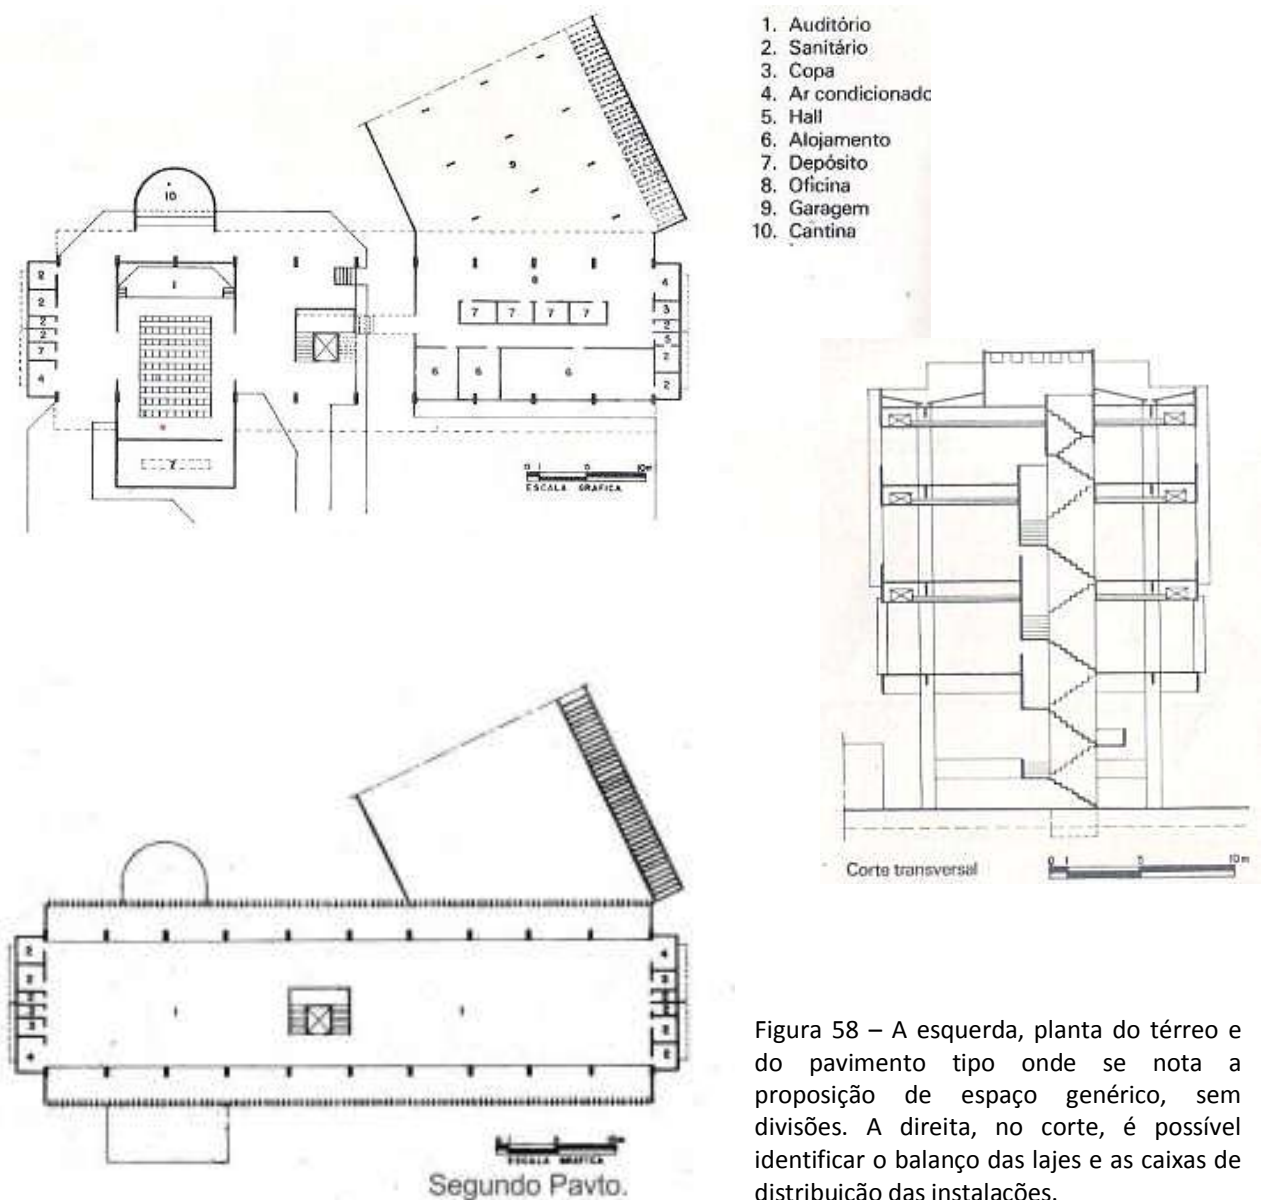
A esquerda, planta do térreo e do pavimento tipo onde se nota a proposição de espaço genérico, sem divisões. A direita, no corte, é possível identificar o balanço das lajes e as caixas de distribuição das instalações.
